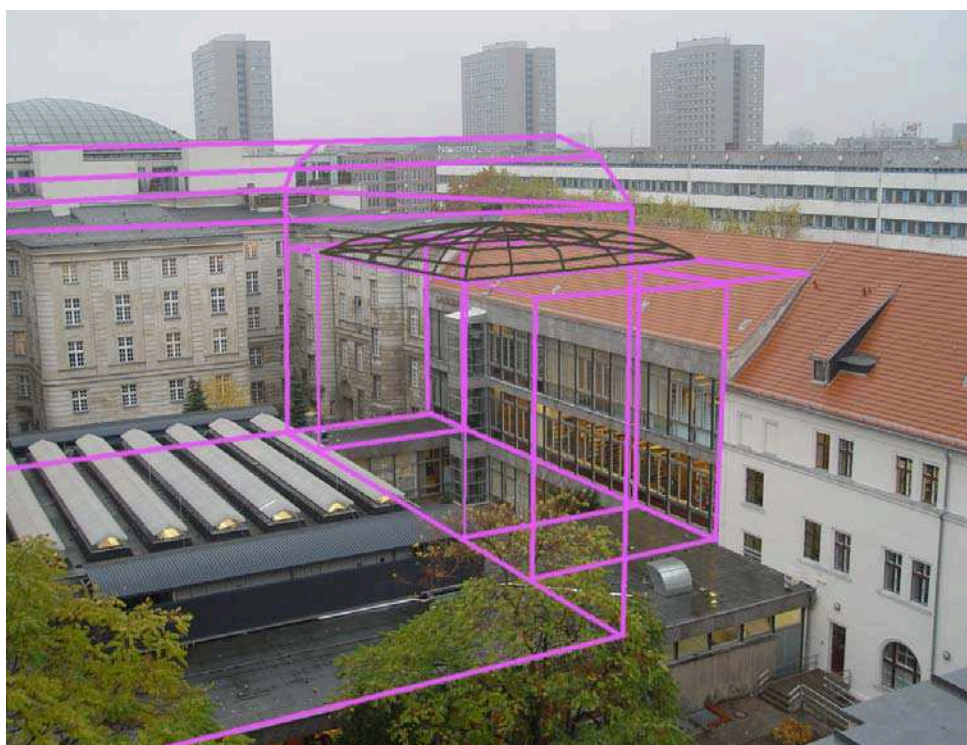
Höhenreduzierung der Überbauung in Richtung Haus 1, Überdachung des Lichthofes
